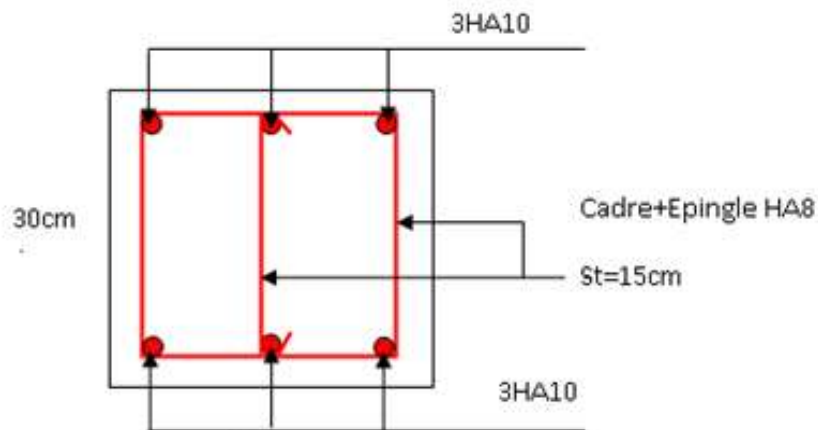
schéma de ferrailage de la poutre de chaînage
